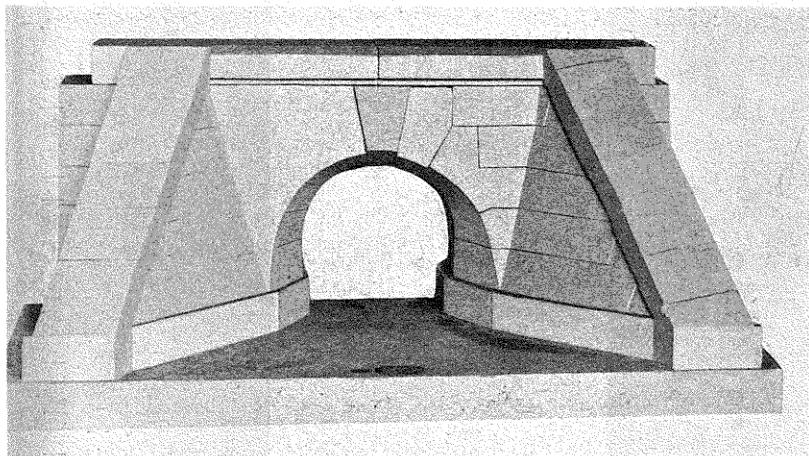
Ponceau droit avec voussure d'évasement et murs en aile
